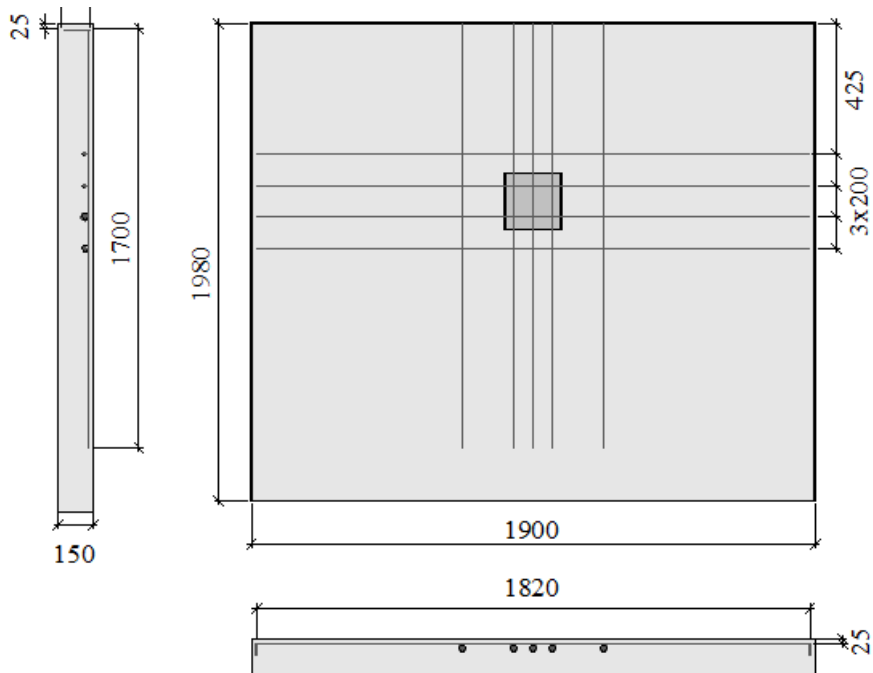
Disposição da armadura tracionada para lajes com *overhang* – Dilger (1989)
